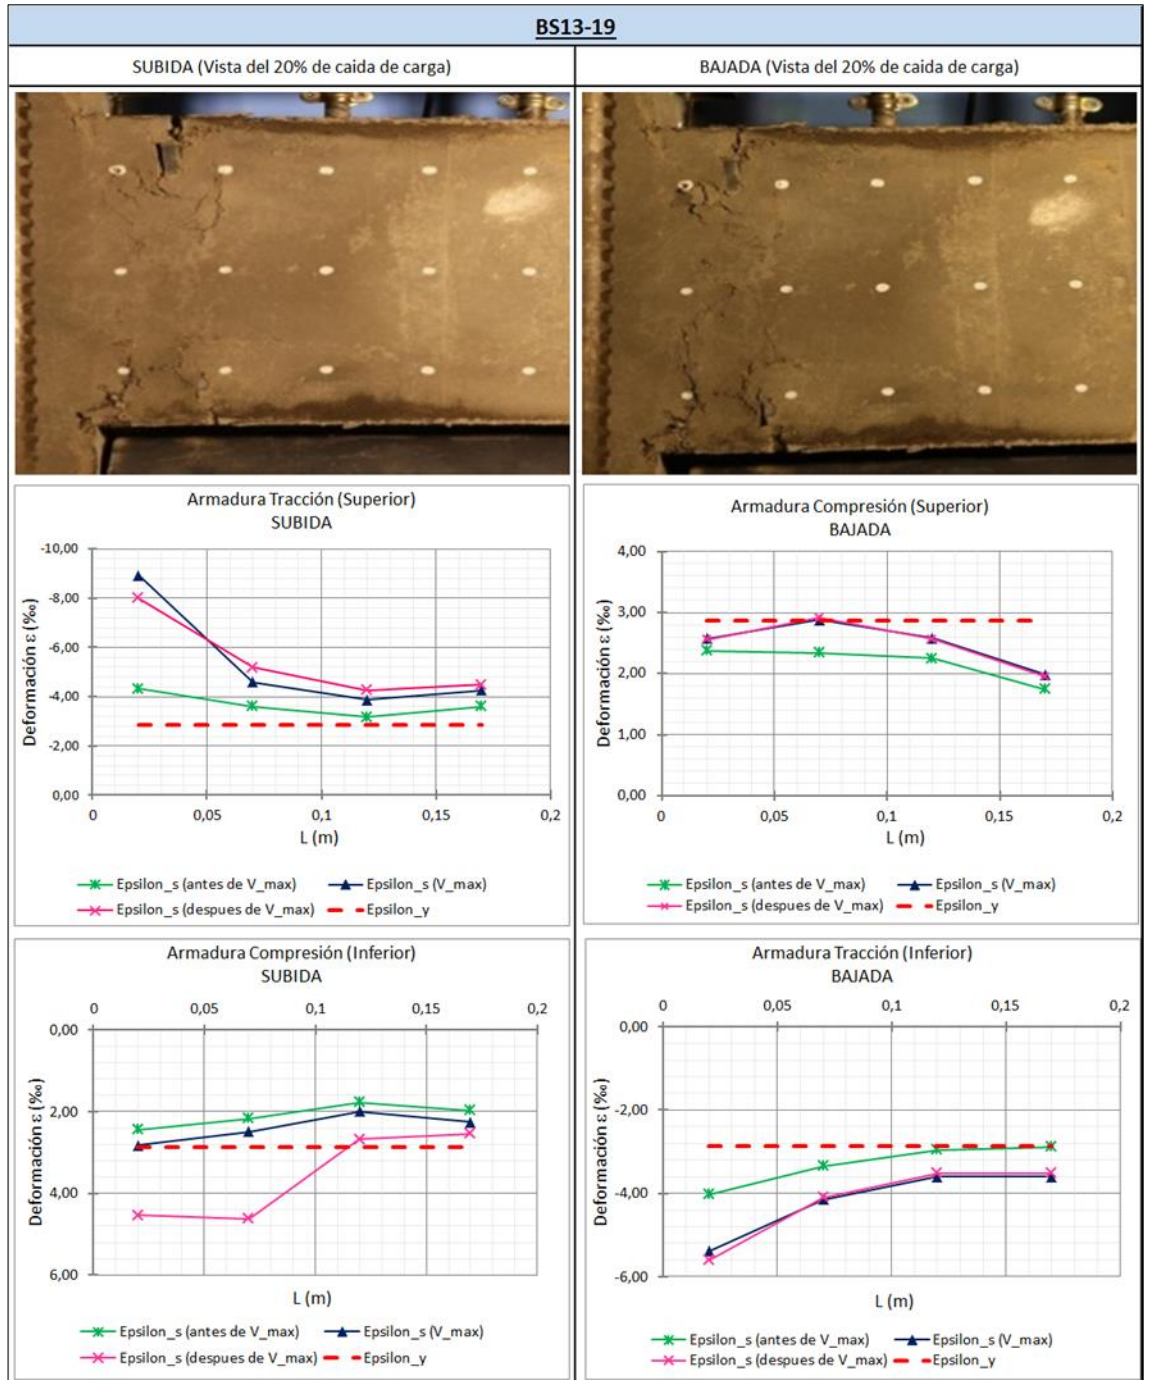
Perfiles de deformación en subida y bajada (BS13-19)
